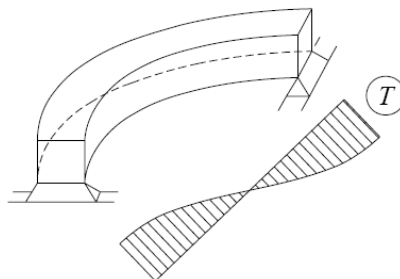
Viga curva no Plano Horizontal [13]
